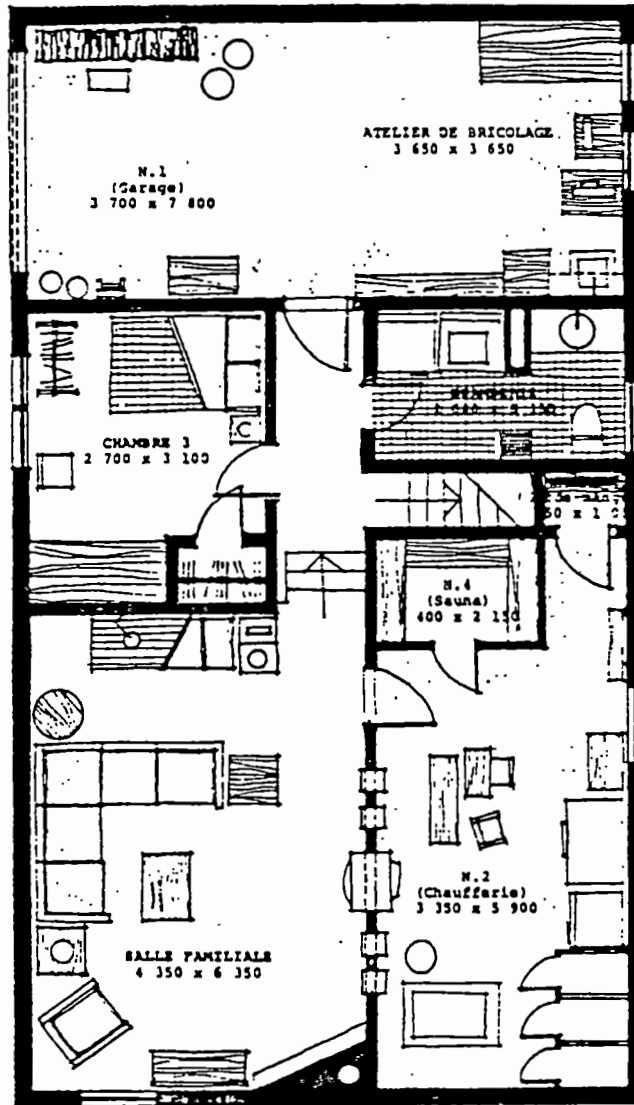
Plan du sous-sol du "split-level" de la Famille 10. Dans cette maison, le regroupement de la salle de toilette, de la buanderie, de l'escalier, du garde manger, du sauna et de la chaufferie a facilité l'aménagement de la salle familiale et de la chambre 3(1070). Échelle: 1/100.
